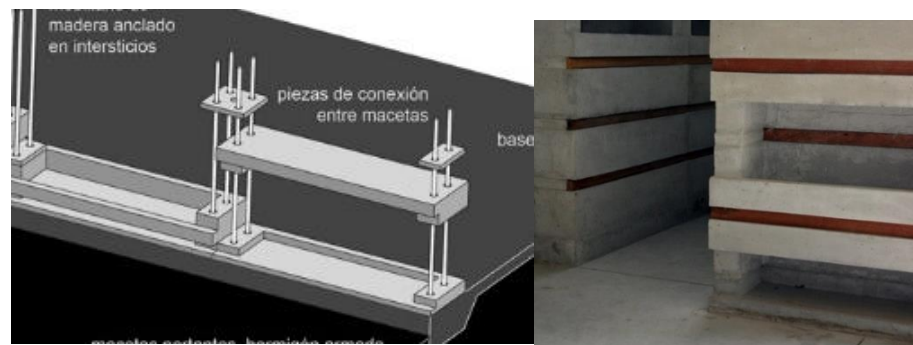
MÓDULO PRÉ-FABRICADO EM BETÃO
